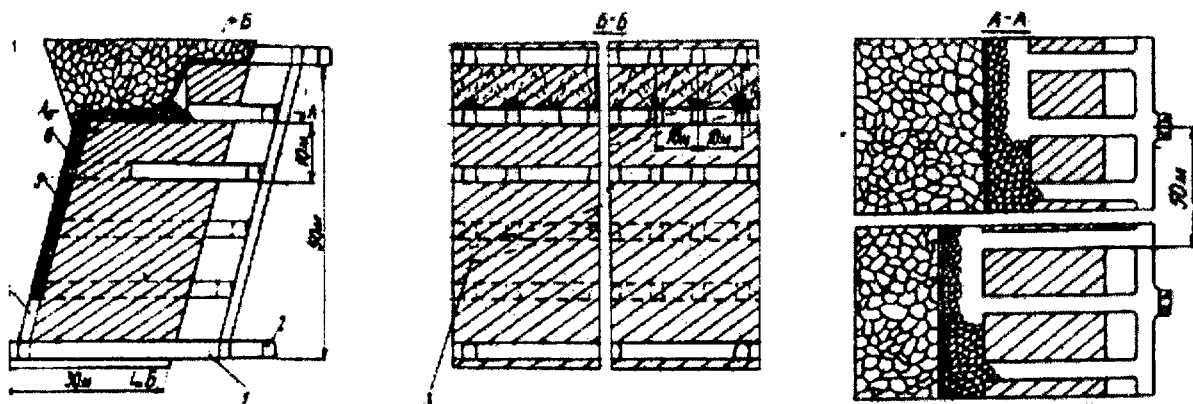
Система поэтажного обрушения с канатно-металлическим перекрытием:
